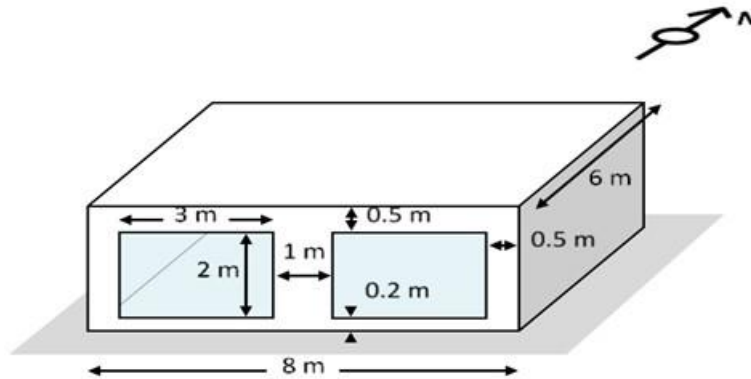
Plano de planta del Caso 900FF de BESTEST.
